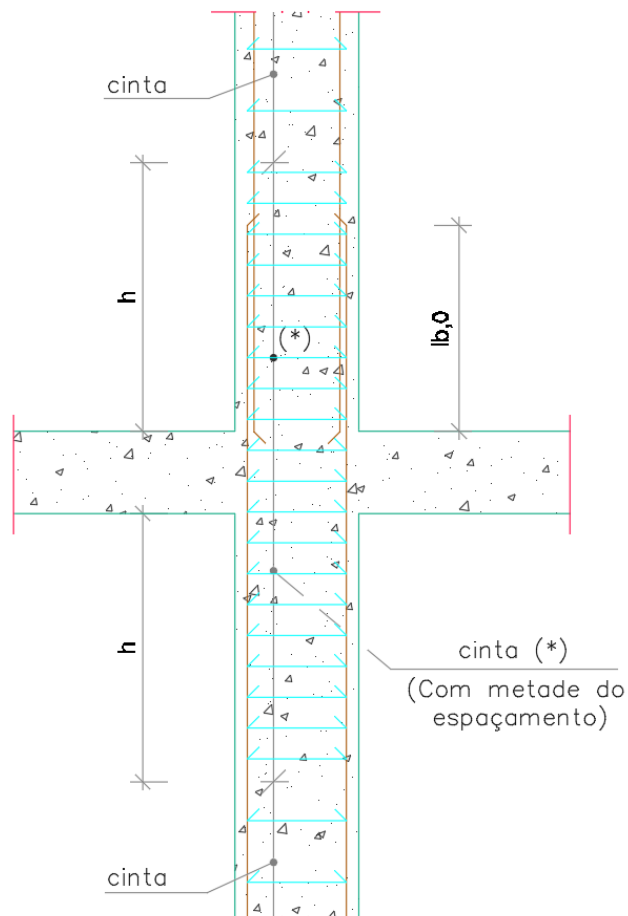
Pilares com seção constante (Projeto de estruturas).
